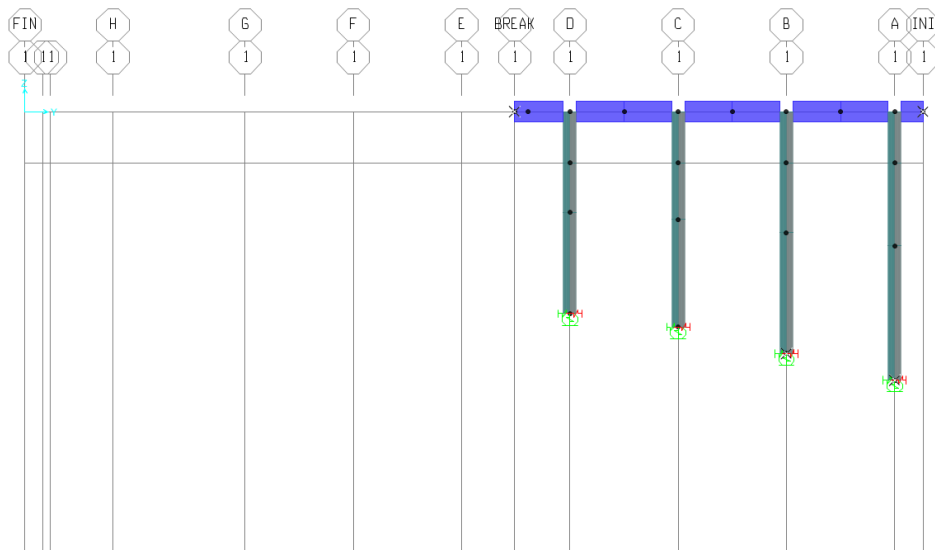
Vista en elevación del plano I de modelación, paralelo a plano Y-Vertical'.
